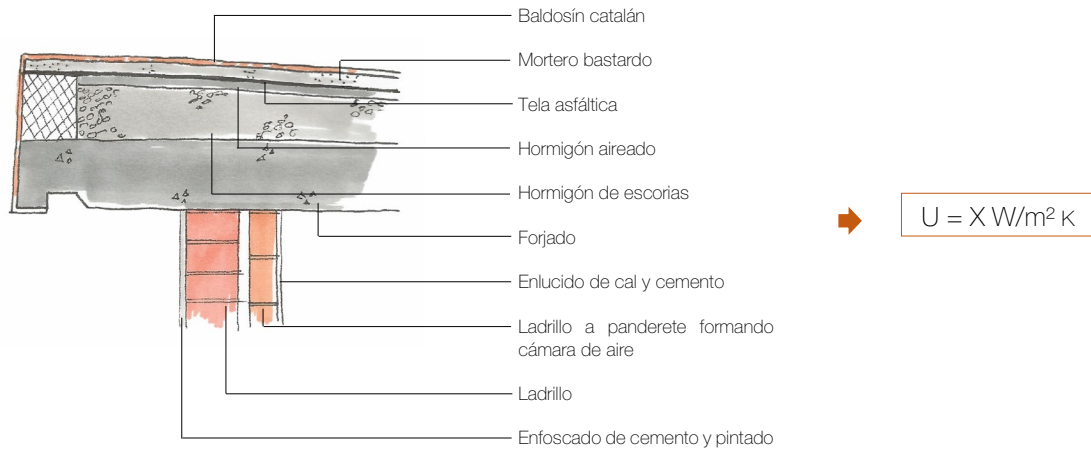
Detalle en sección de la cubierta plana (autoría propia).
